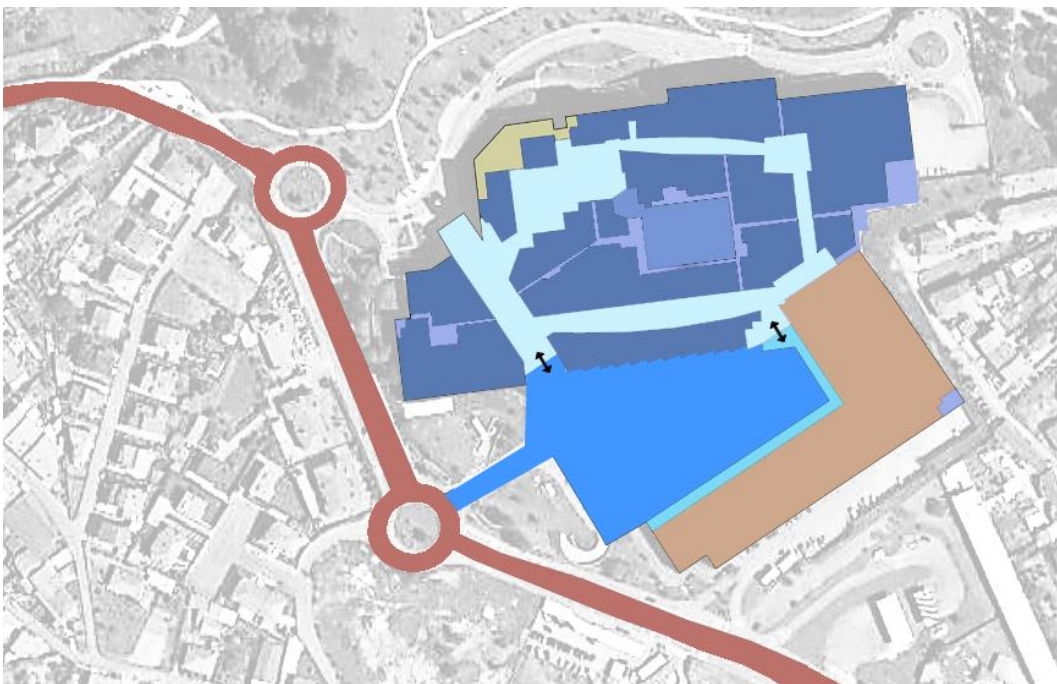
| Planta esquemática do piso -1 do Espaço Guimarães
